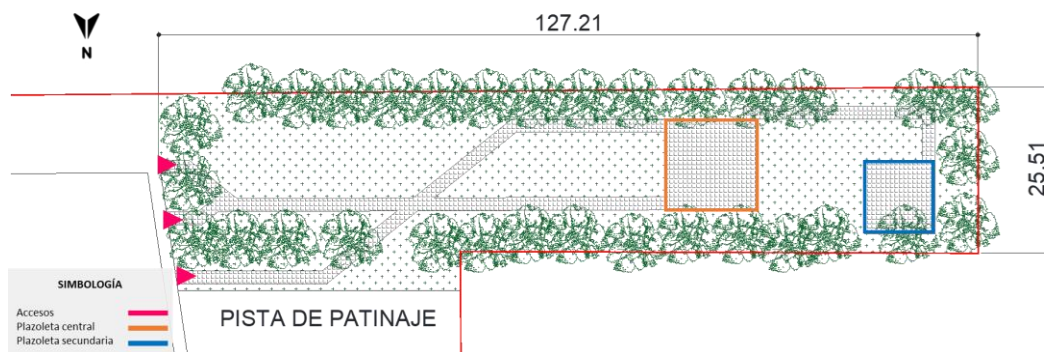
Planta arquitectónica de la segunda sección de la Zona de Meditación. Fuente: Elaboración propia con base en Google, 2024.
